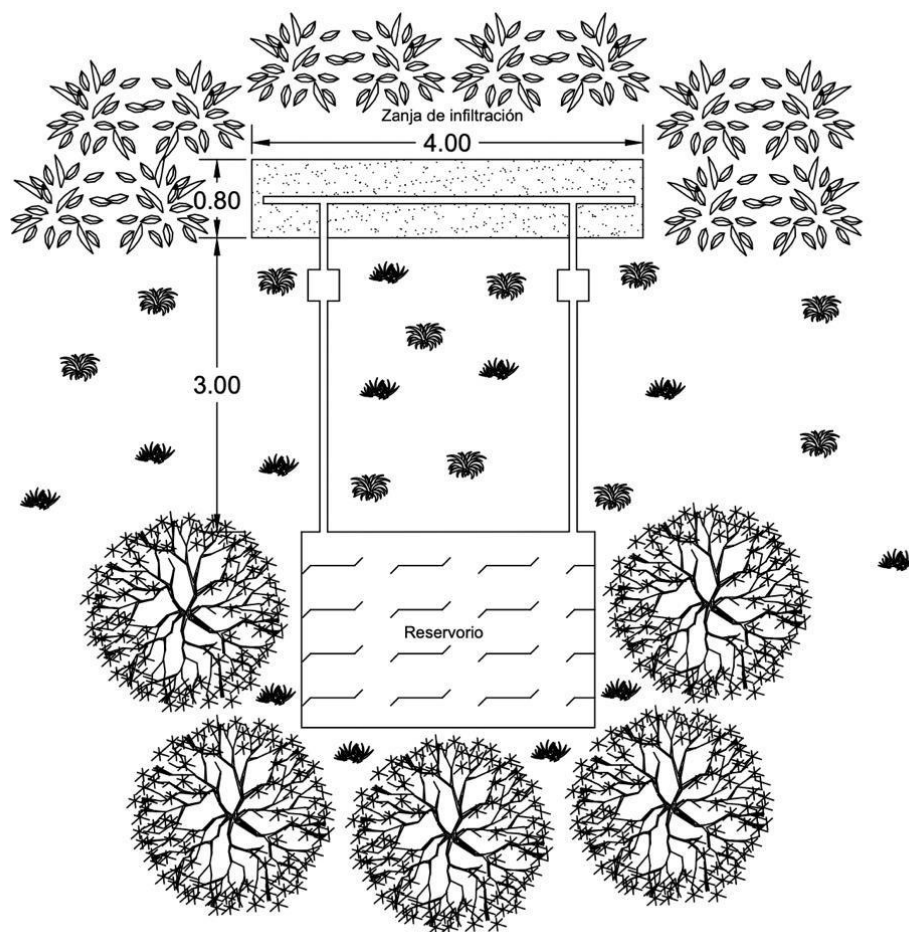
Zanja de infiltración vista en planta. Fuente. Gamboa, 2023
